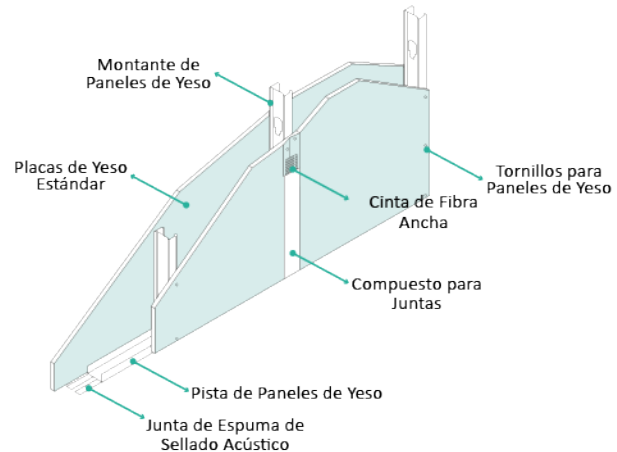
Detalle de los Paneles de Yeso Colocados en Montantes Metálicas.
